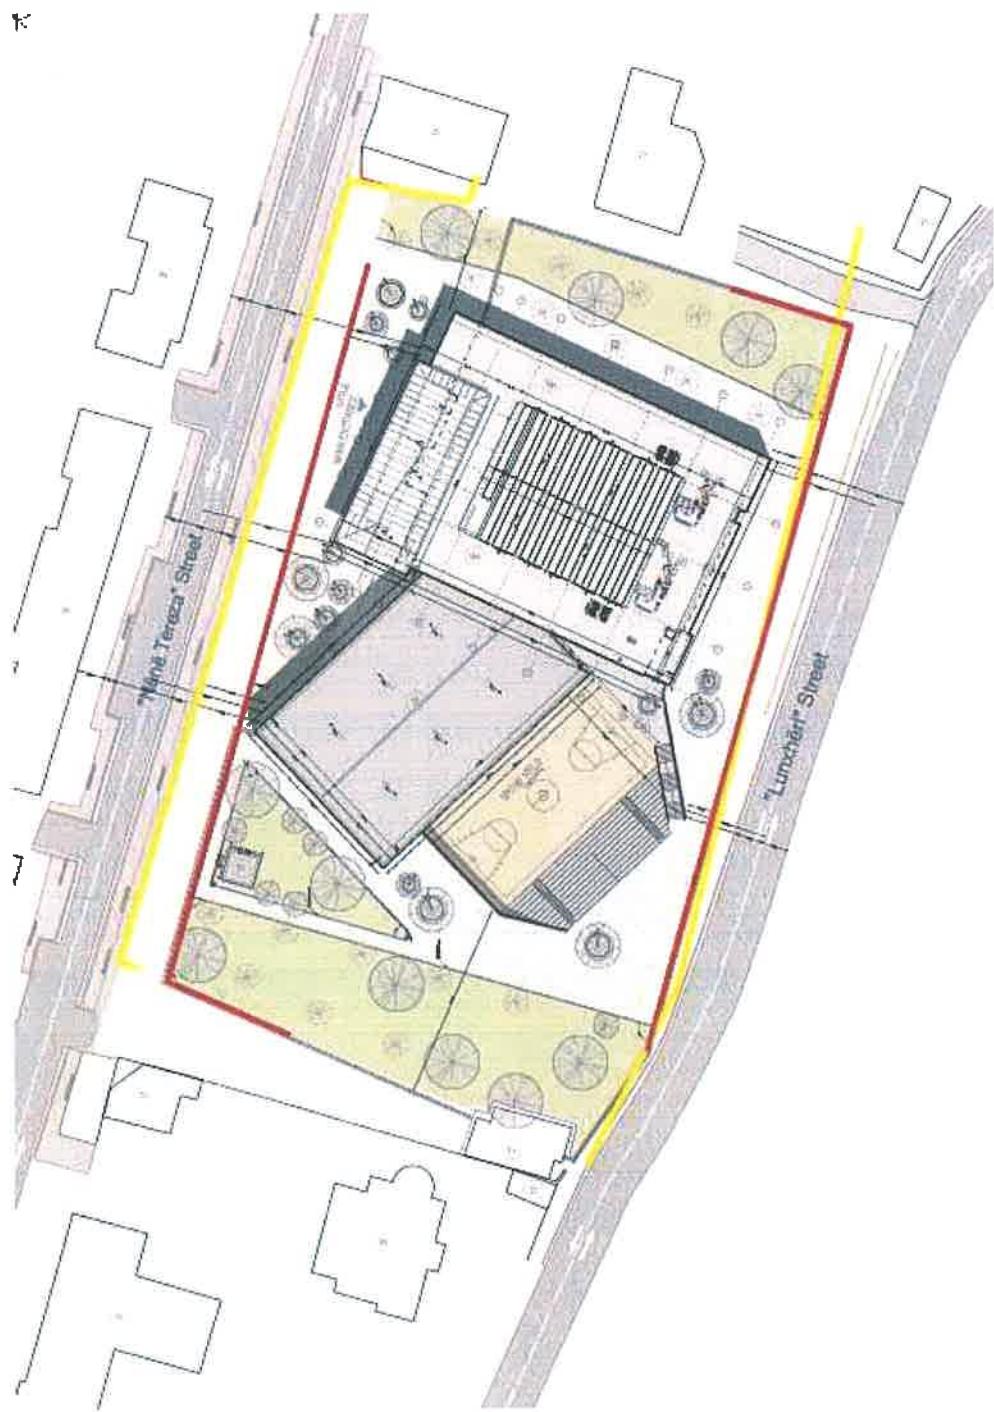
\_ Planvendosja e Shkollës "Sulejman Elezi"
